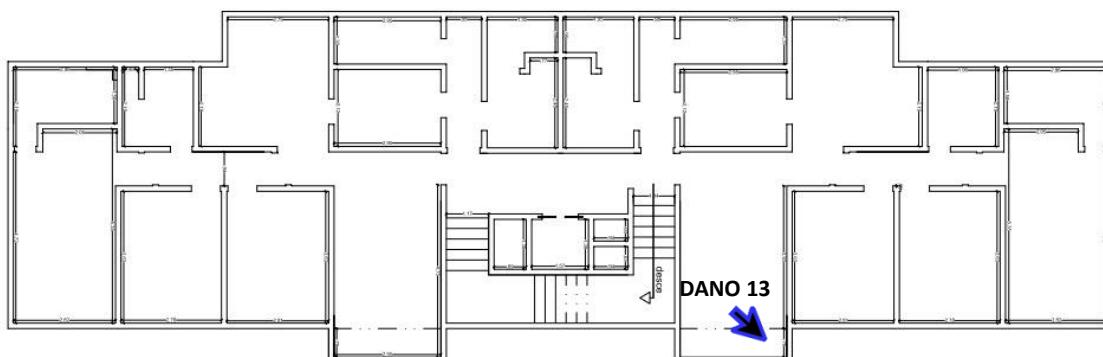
Planta Baixa (croqui) do Pavimento do 5º andar – Bloco A – Cond. Armando Lôbo.
